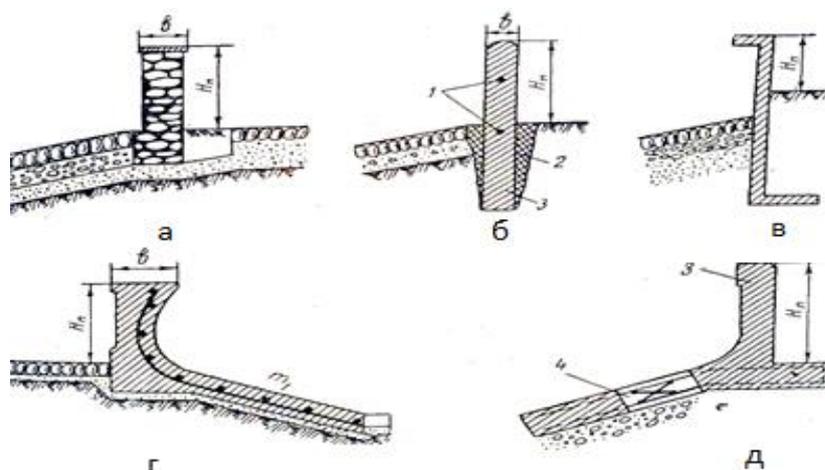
Возможные конструкция парапетов: а – из бутовой кладки; б – из бетонных сборных плит; в – из сборных железобетонных плит; г – из монолитных армированных бетонных плит с криволинейной поверхностью; д – из сборных армированных бетонных плит; 1 – пироны; 2 – бетон; 3 –плита парапета; 4 – стык плиты и парапета
